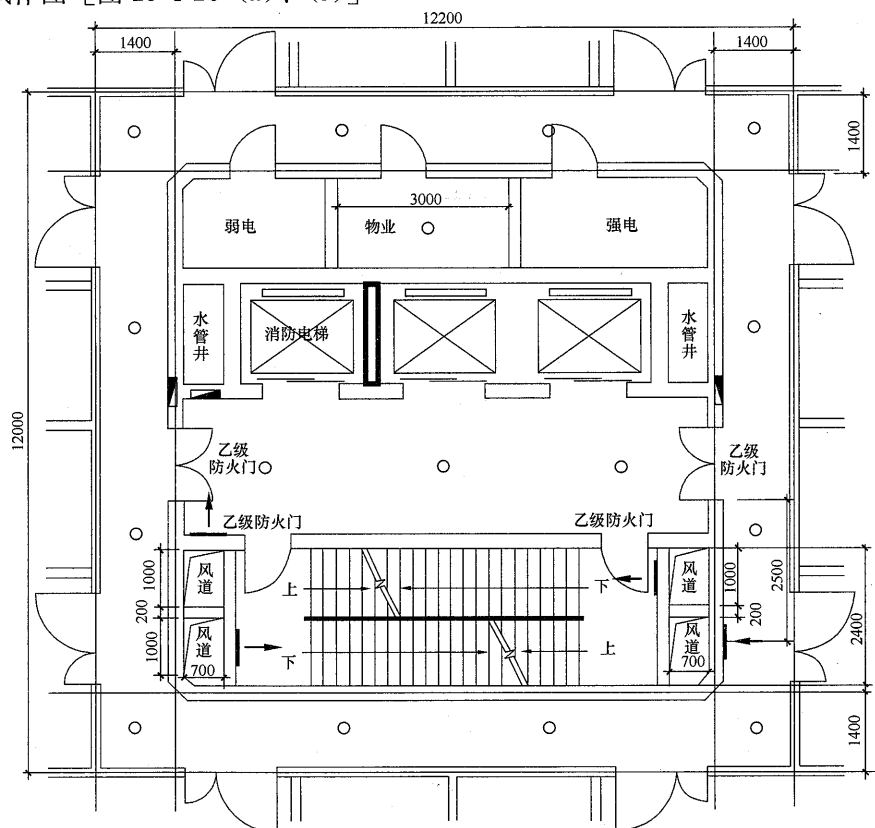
(a) 24 层高级公寓标准层平面图 (参考答案)
